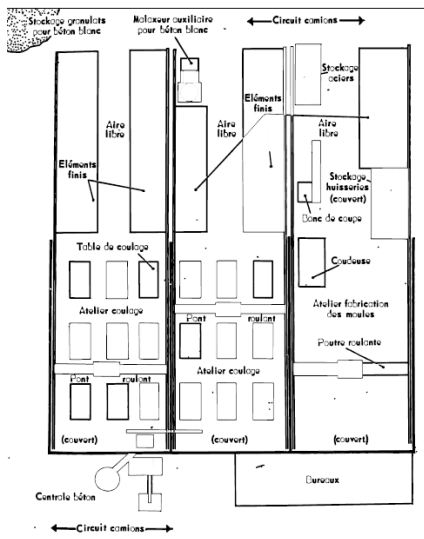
Exemple de plan d'aménagement d'un atelier de préfabrication
